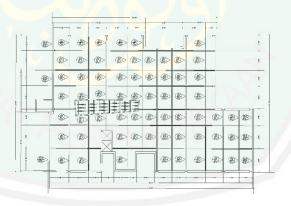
Denah rencana pembalokan Basement UG berjenis waffle beton
